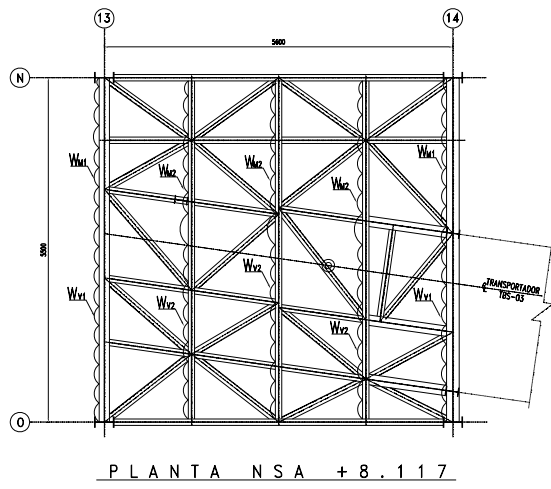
Plantas de Operación TT-3, con cargas distribuidas y estructuración
